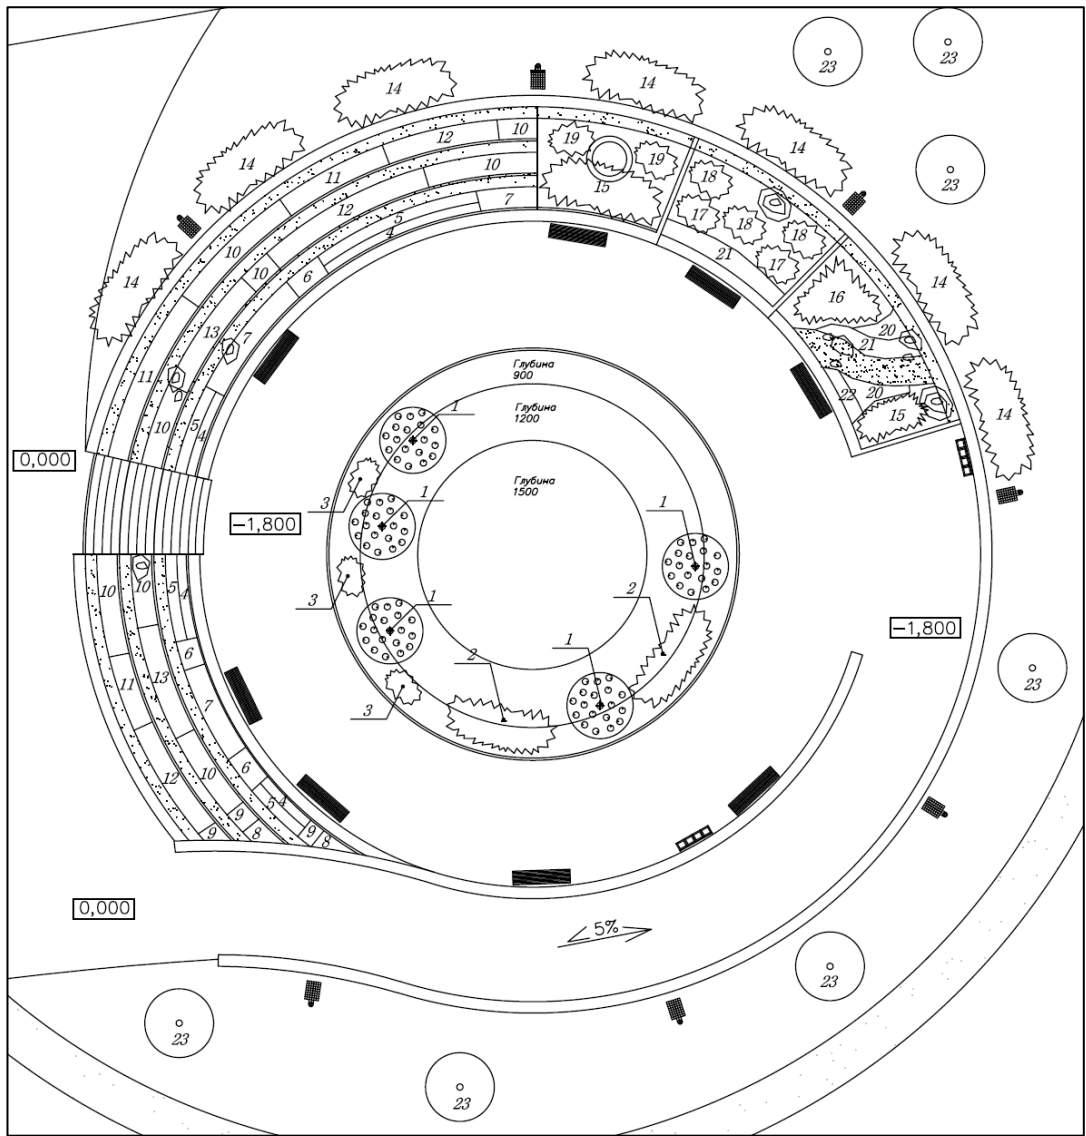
Фрагмент генплана 14, схема посадки растений для зоны пруда
